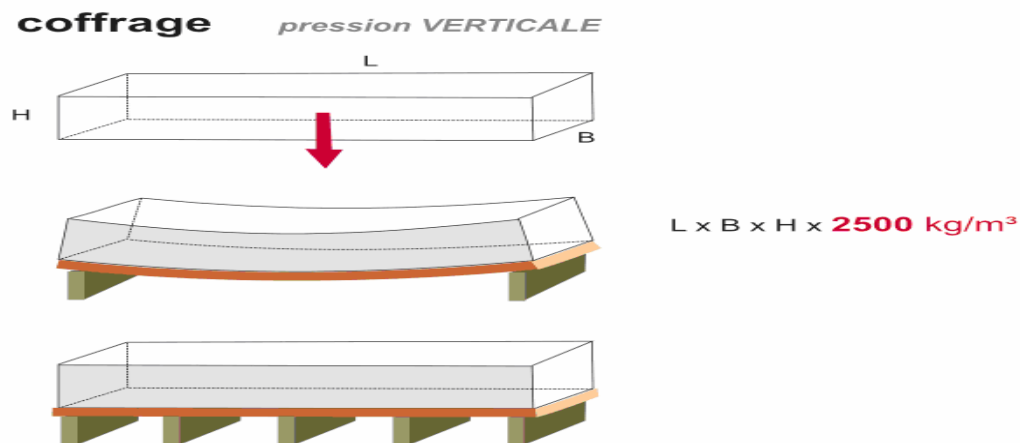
Pression verticale exerçant sur le coffrage [3]
